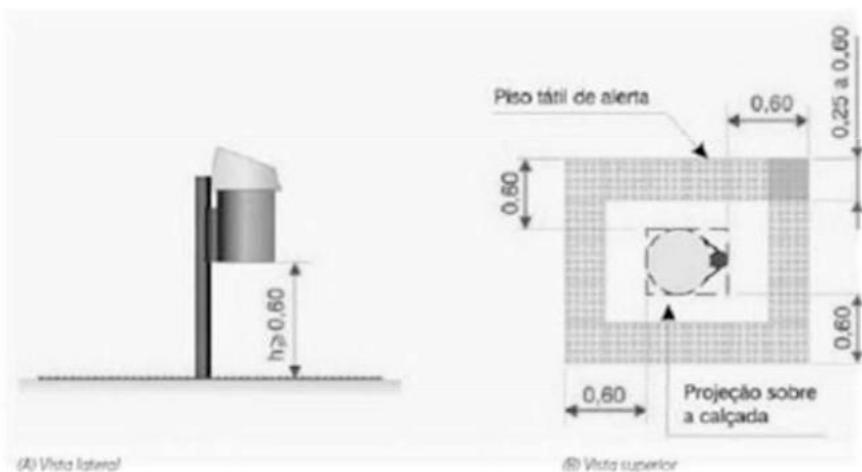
Instalação de piso alerta para obstáculos. Fonte: Projeto Calçada Acessível.
